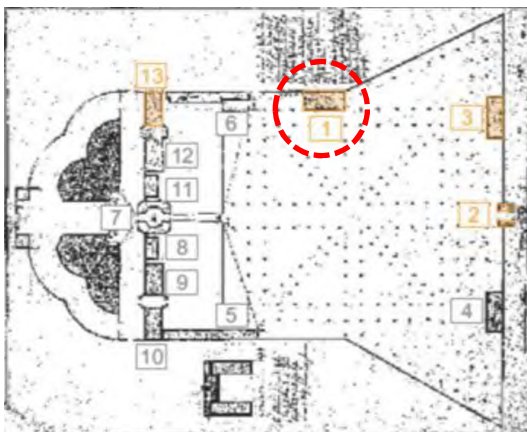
Lageplan Hofgut Amalienberg mit Zehntscheune
